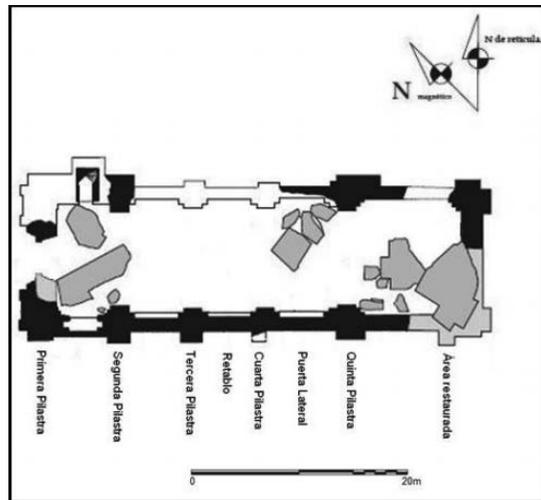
Plano del pilastro en muro sur (Dibujo: I. Zeceña 2015).
